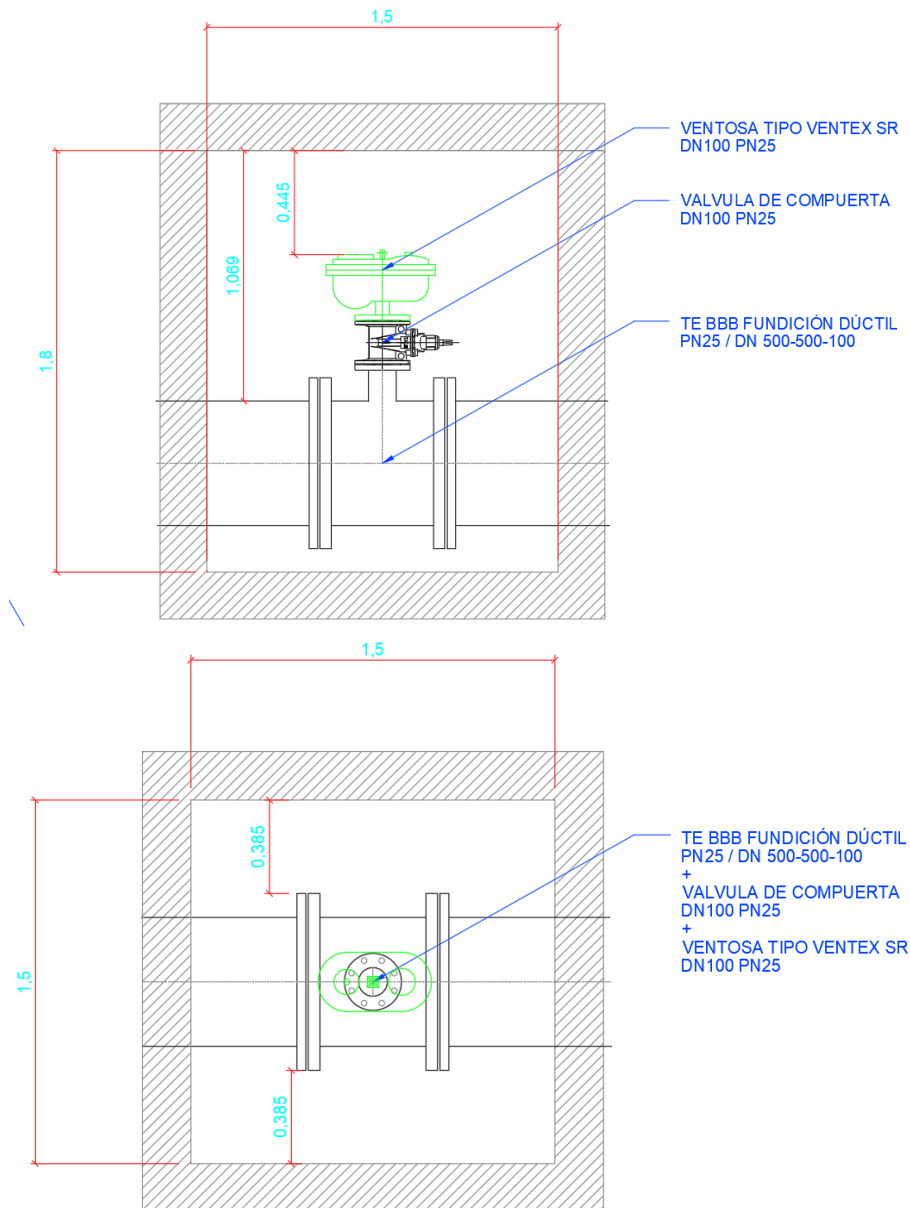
Alzado y planta de la arqueta para instalación de ventosas. Fuente: Elaboración propia
